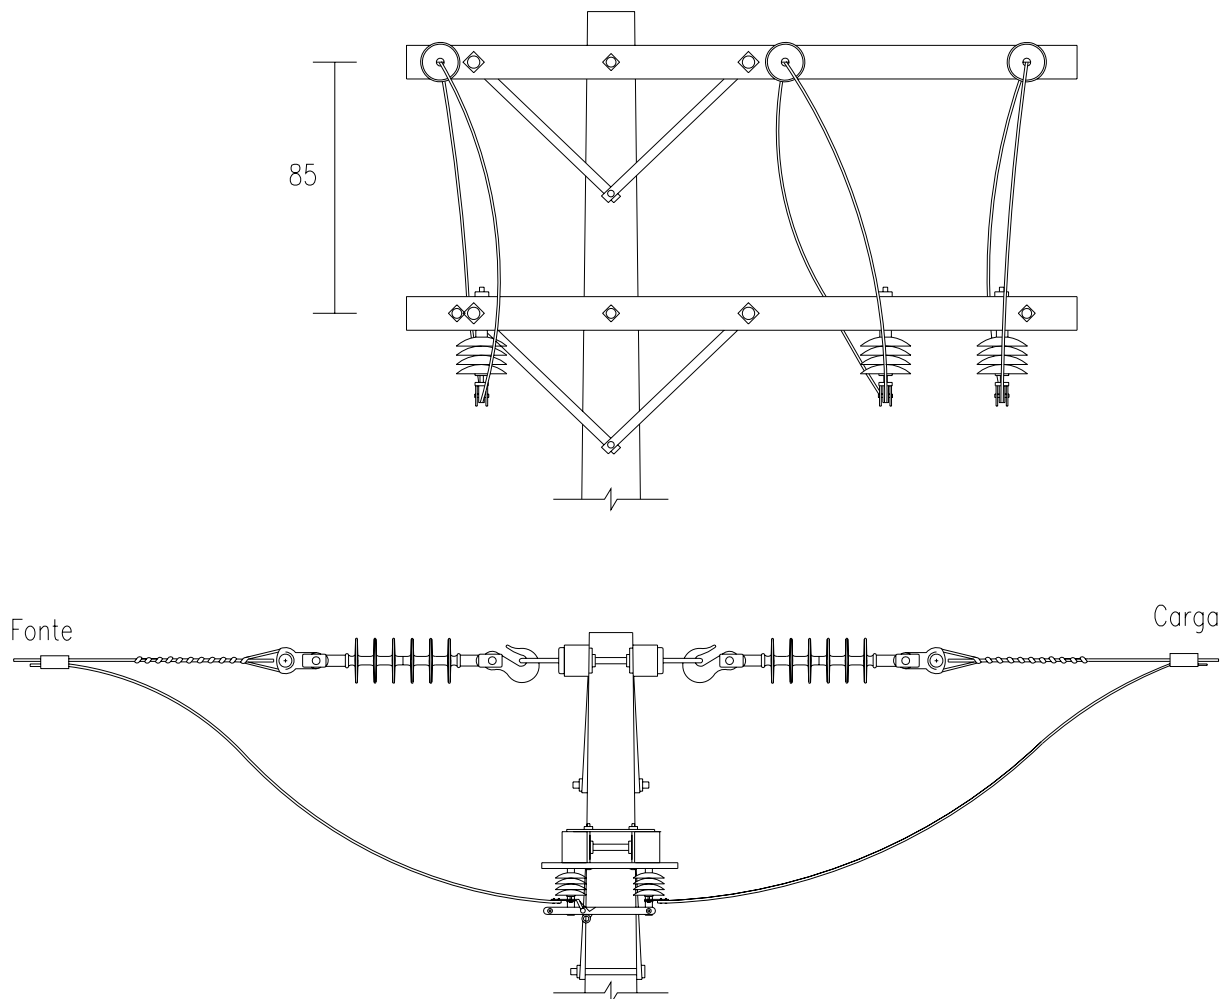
Estrutura M4 chave faca (manobra) (montagem alternativa)
